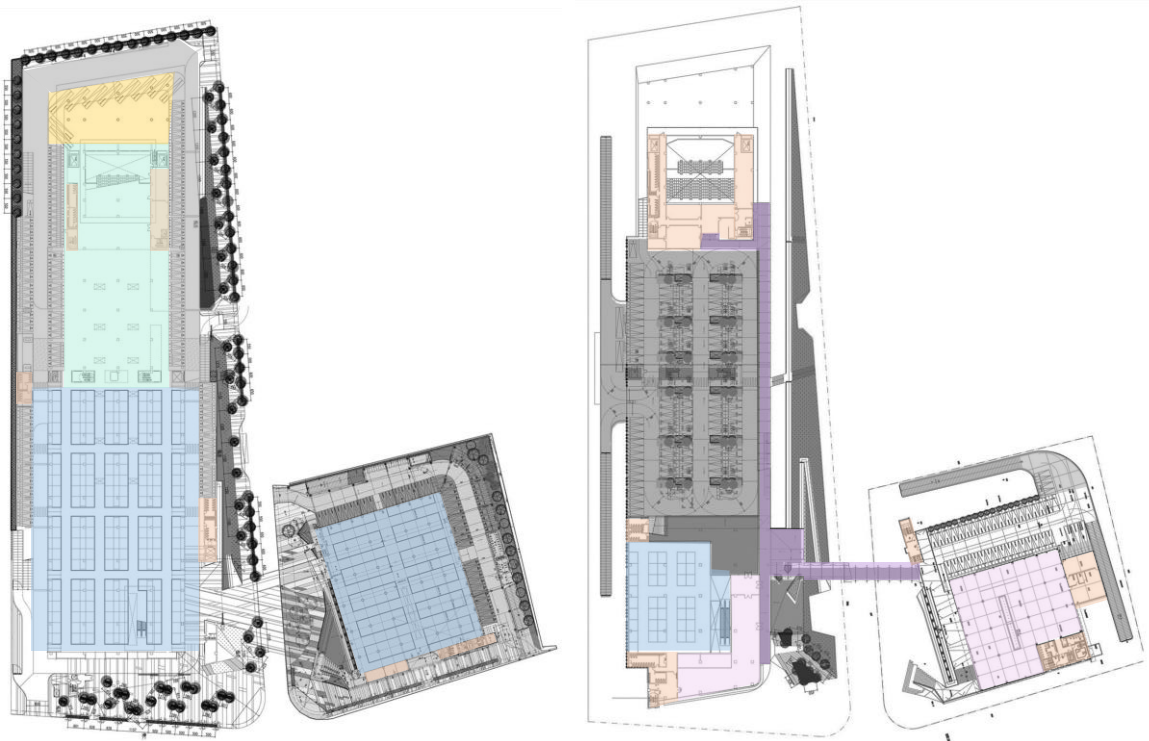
Plantas del Mercado Mayorista de Flores de Taipei
